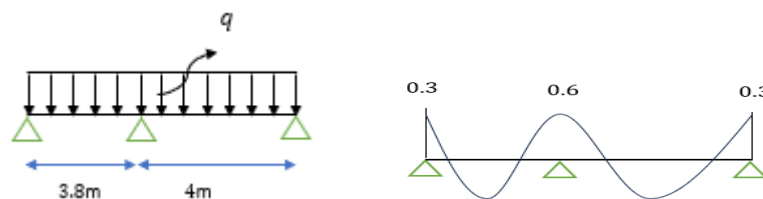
Schéma statique de la poutrelle appuyée sur 3 appuis.
